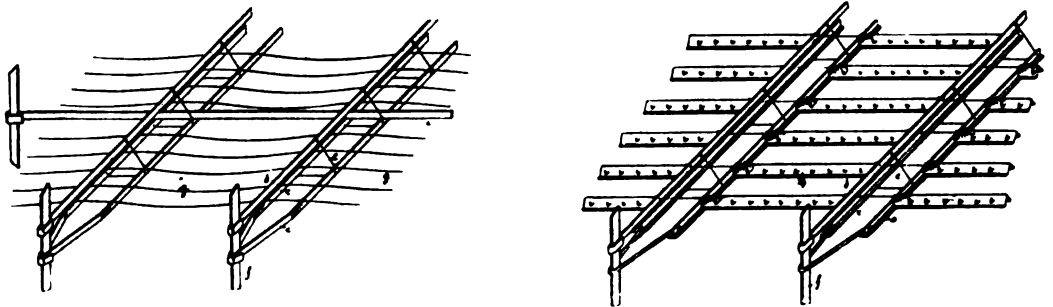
u. 429. Steineisendecke, System Lolat, Anordnung der Eiseneinlagen.
